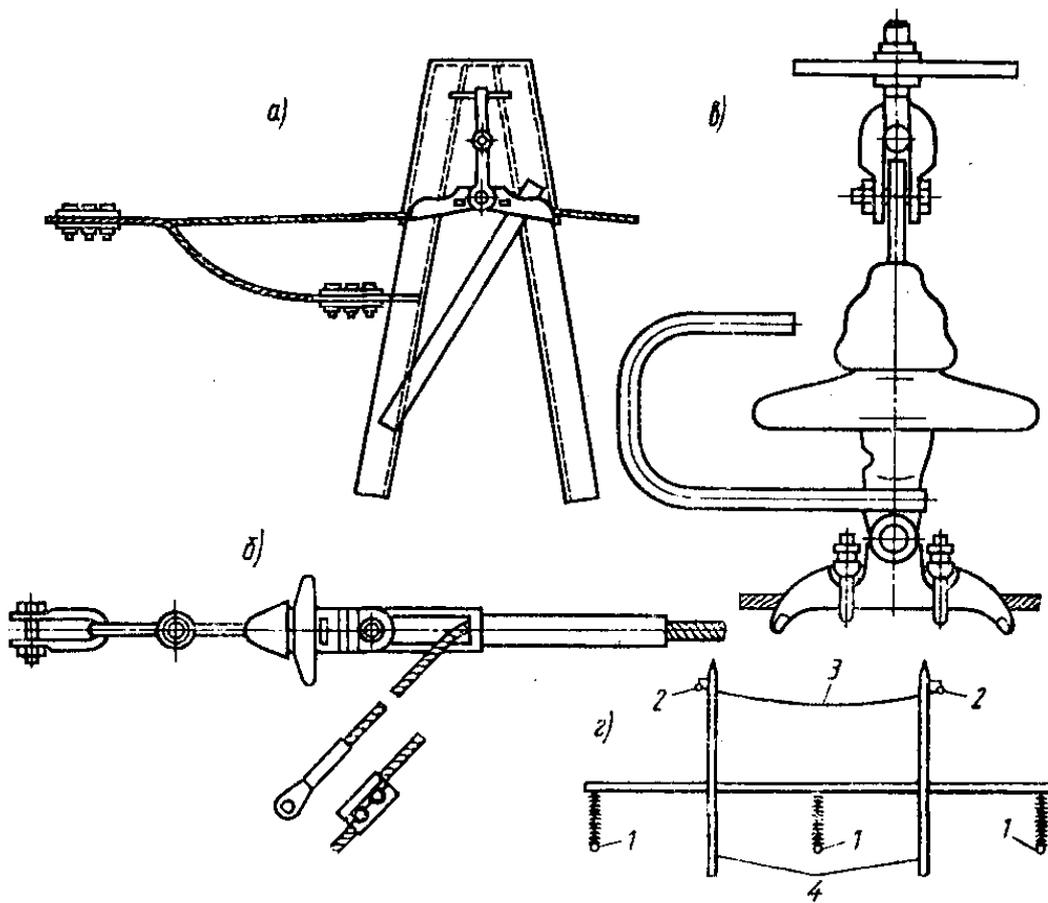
Крепление грозозащитного троса на опорах: *а* - на промежуточных металлических и железобетонных опорах линий 35...110 кВ; *в* - на анкерных металлических опорах через изолятор с глухим заземлением; *в* - на промежуточных опорах через изолятор с заземлением с помощью искрового промежутка на линиях напряжением 220... 500 кВ; *г* - на деревянных опорах; 1 - провода; 2 - тросы; 3 - перемычка между грозозащитными тросами; 4 - спуски
